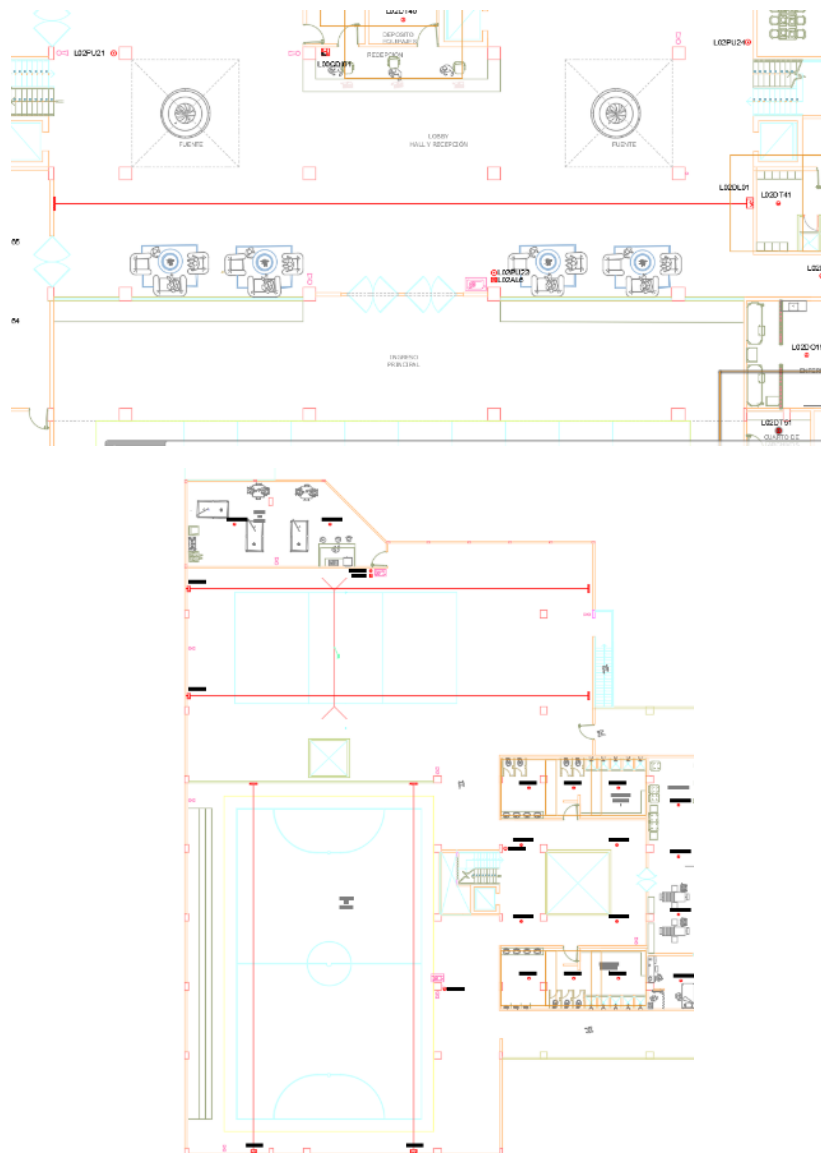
Ejemplos disposición final y coberturas en planos. Planta Baja y primera. Detectores lineales. Planos del proyecto
